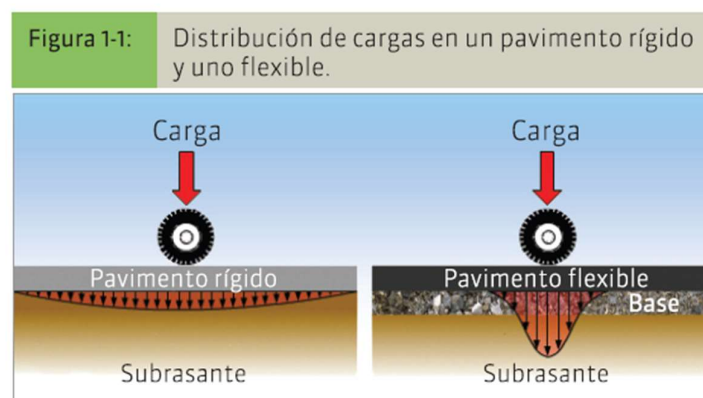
| Transmisión de cargas a la subrasante en pavimentos flexibles y pavimentos rígidos.
